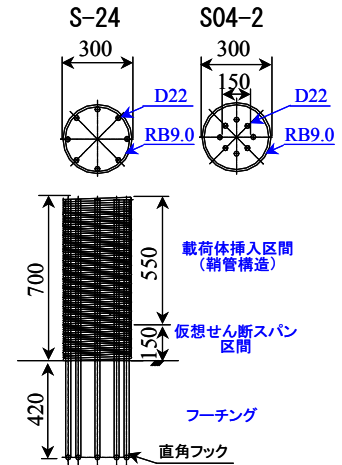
試験体形状寸法および配筋例 (S-24, S04-2)
